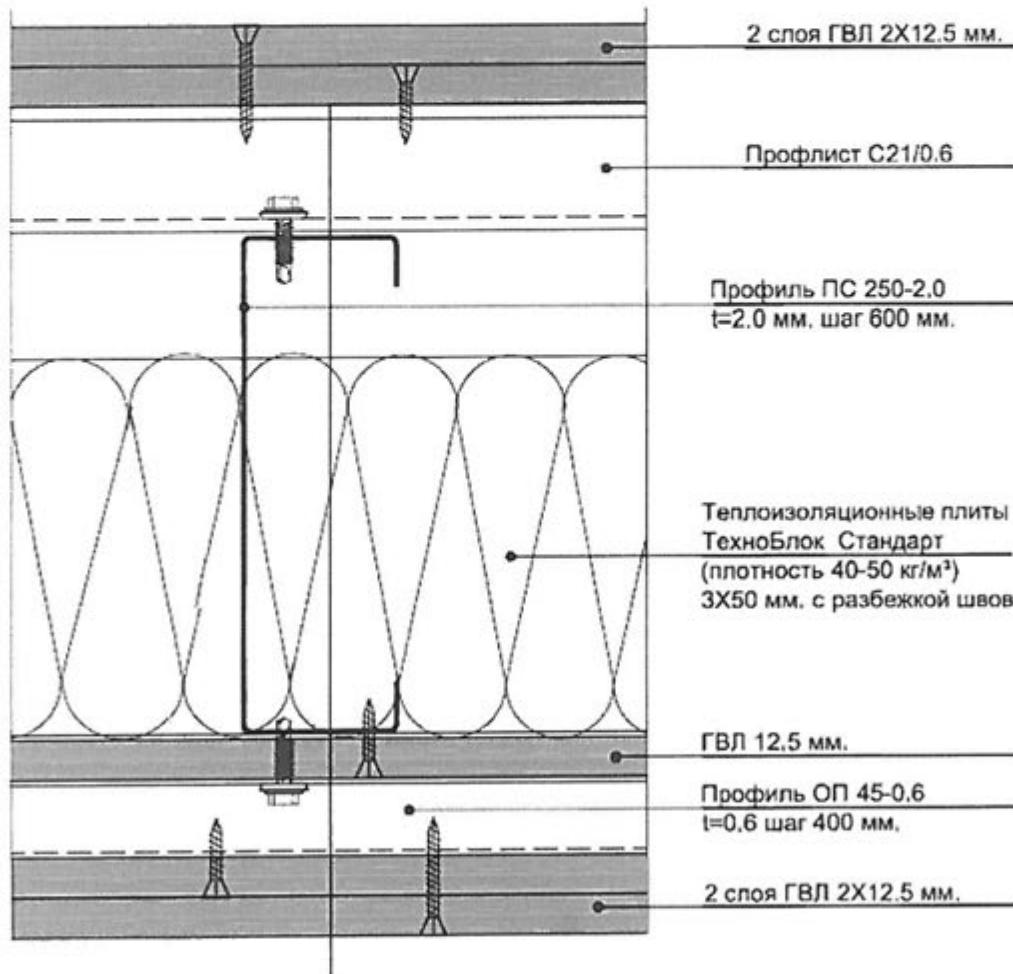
Схема конструктивного исполнения междуэтажного перекрытия (вариант 1).
